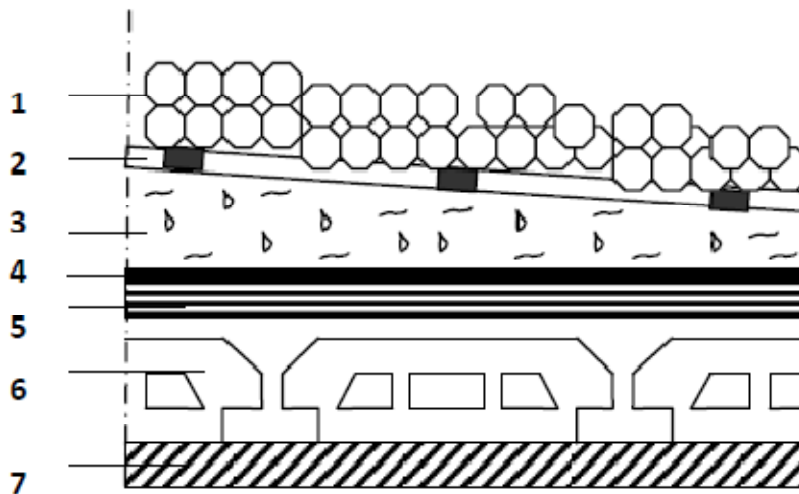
coupe verticale du plancher terrasse inaccessible.
